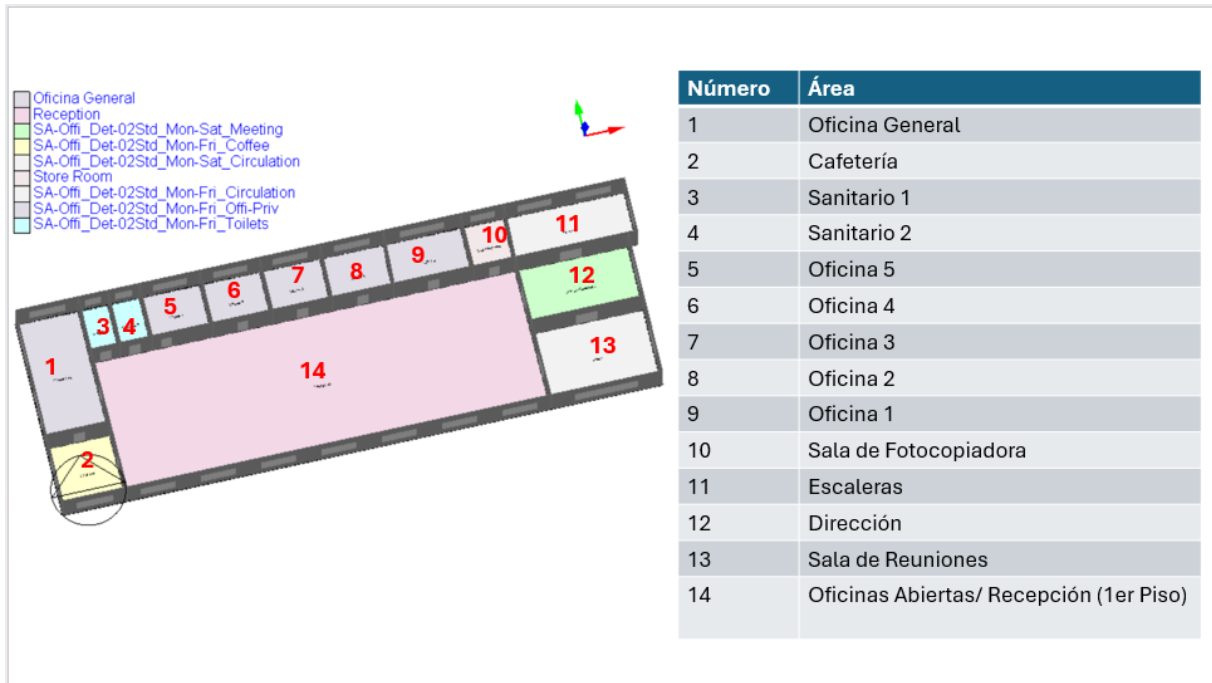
Distribución en Planta del Edificio. (Fuente: Elaboración Propia)
